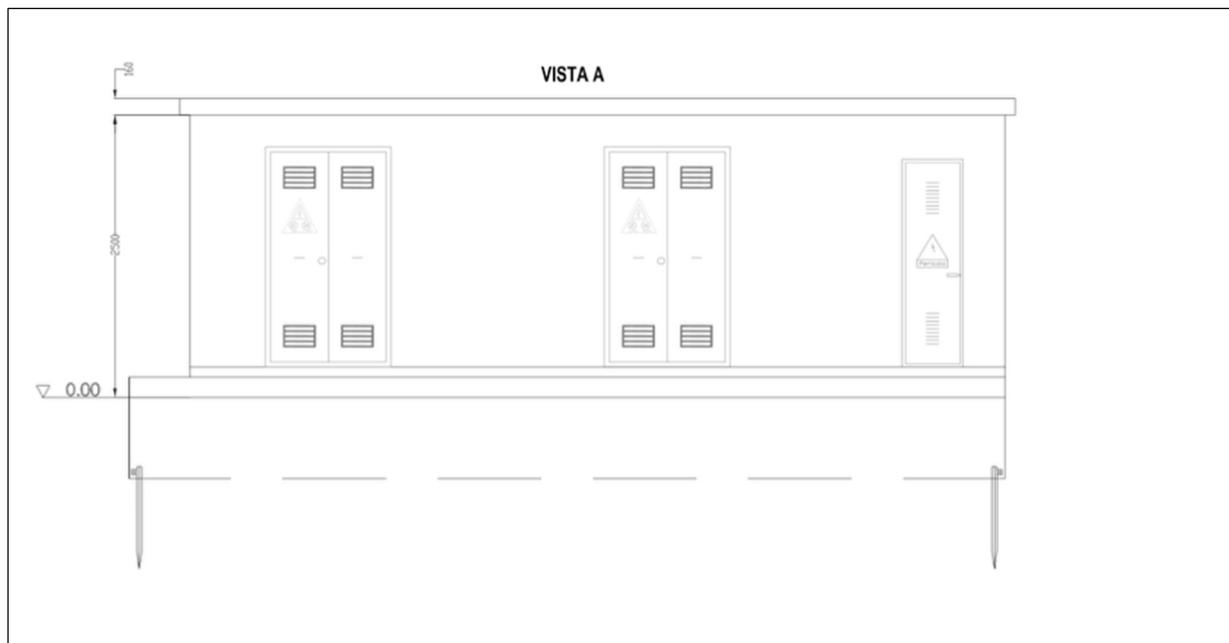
Locale cabina di Parallelo Mt-Prospetto
